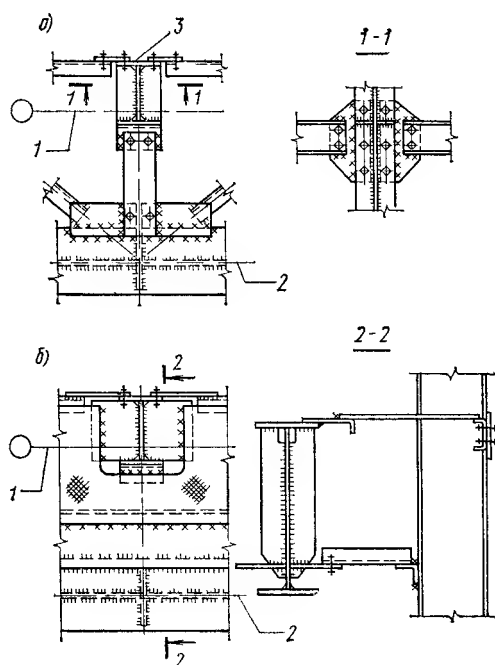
Крепление стойки фахверка к тормозным конструкциям
